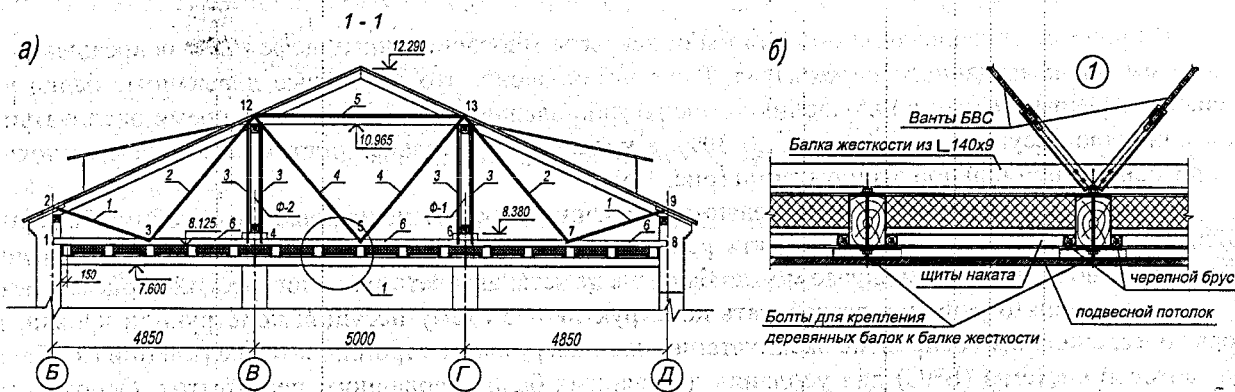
Схема участка перекрытия с продольными фермами Ф-1, Ф-2 и БВС
